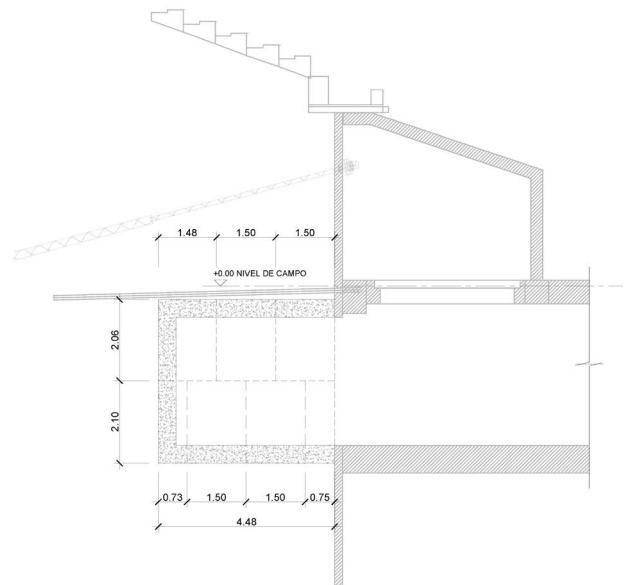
Galerías en mina. Dimensiones bataches de excavación.
